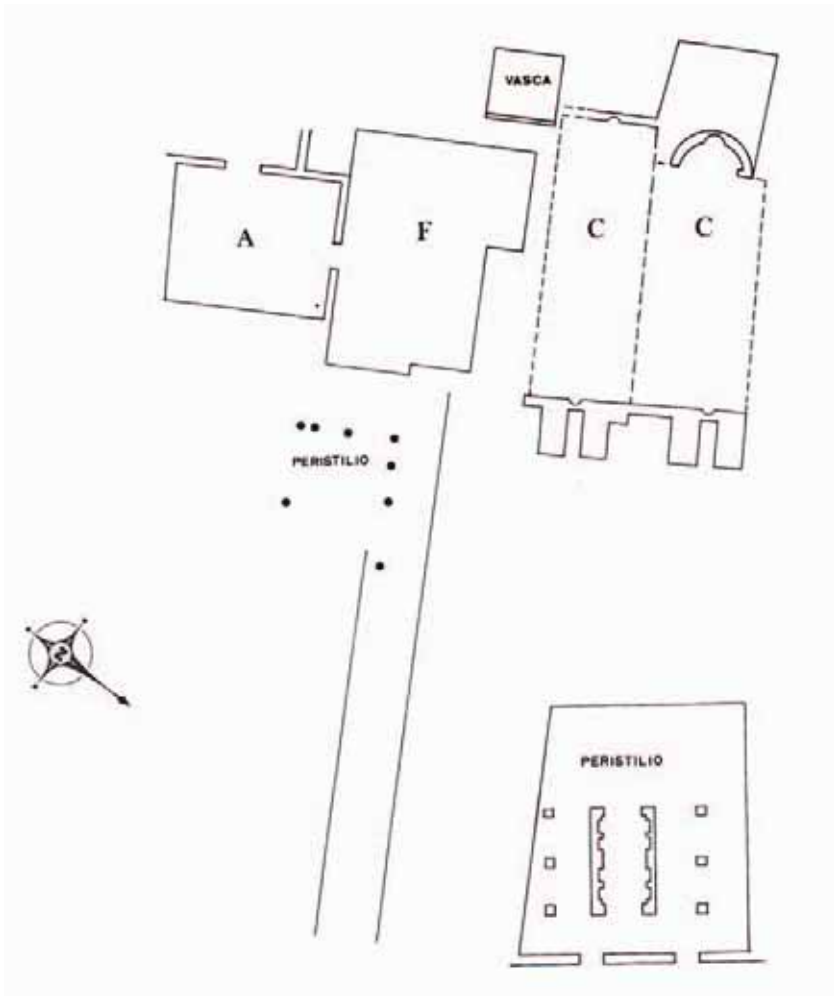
Terme centrali e peristilia adiacenti (schizzo planimetrico)
